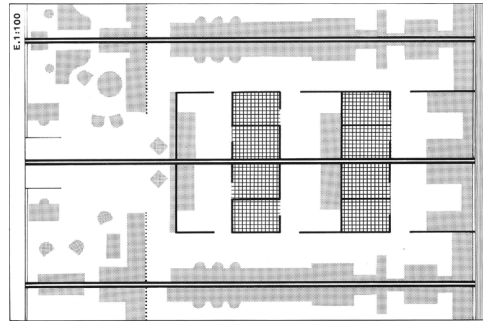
Planta tipo viviendas en la bahía de Santander en el año 2040 (Cabrero 1992: LIV 95).
